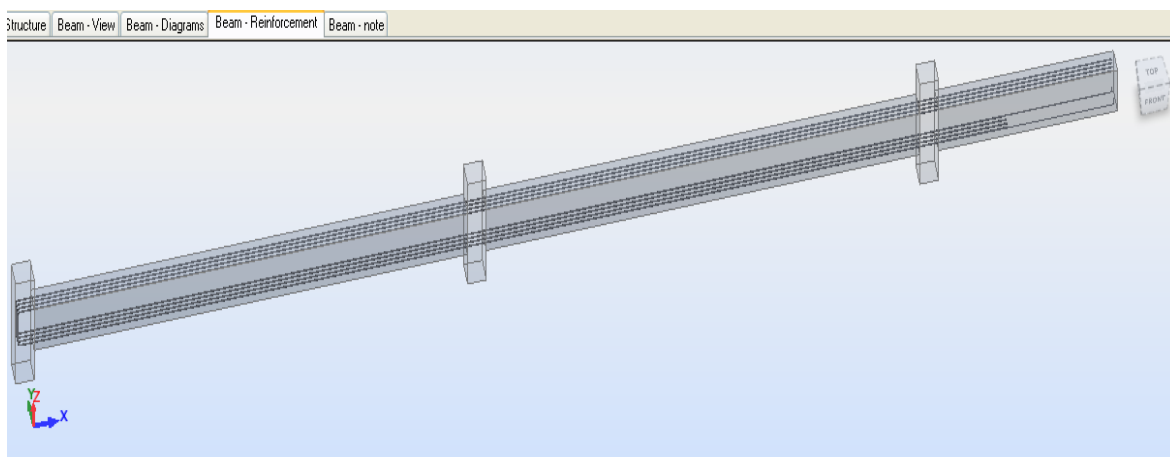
Perspectiva da solução e disposição de armaduras longitudinais do pórtico e piso em estudo (calculado para 5 pontos no elemento)
